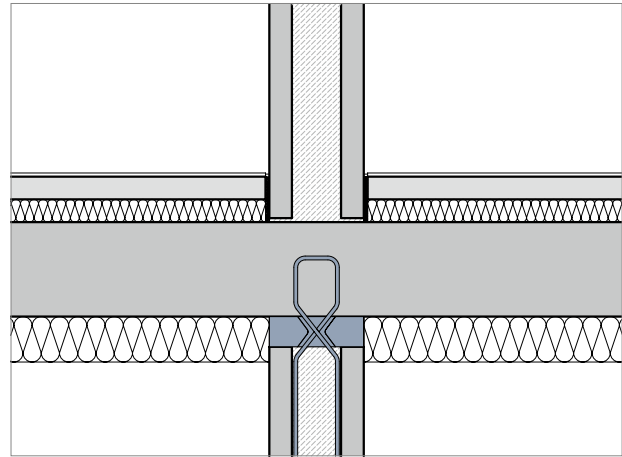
Schematische Darstellung Schöck Sconnex® Typ W bei Doppelwänden und Unterdeckendämmung
